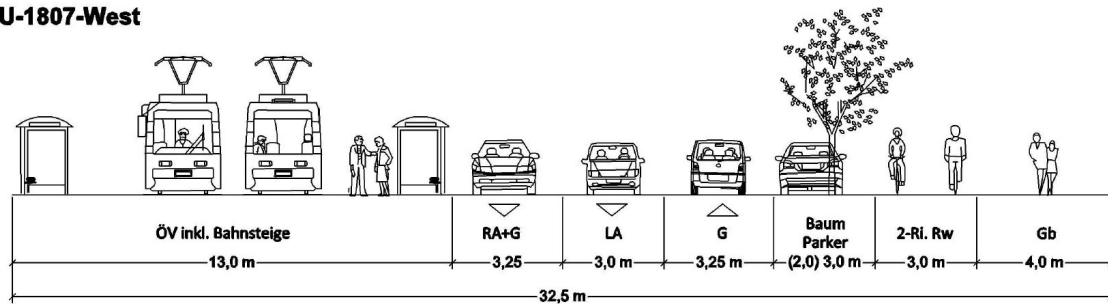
U-1807 im Bebauungsplan (©LHM)
